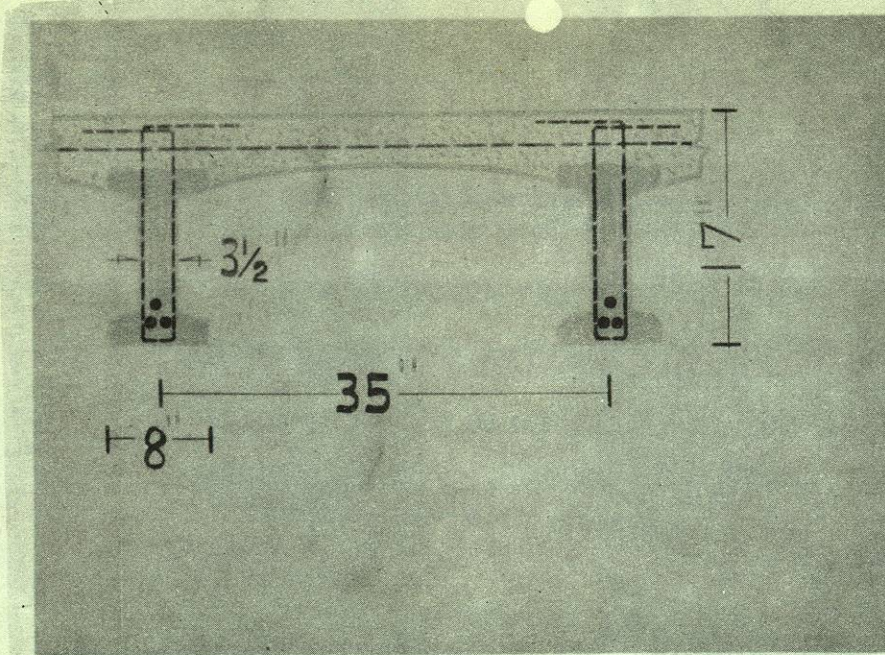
Sistema C. Sección del piso típico mostrando las viguetas prefabricadas y la placa vaciada en sitio.
